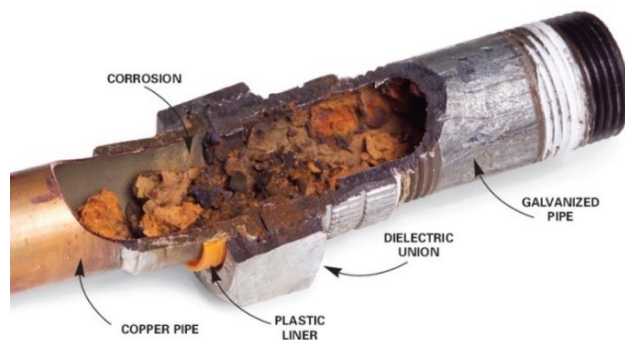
Diferença do nível de corrosão entre tubagem galvanizada e cobre (Armstrong Plumbing, 2011)
